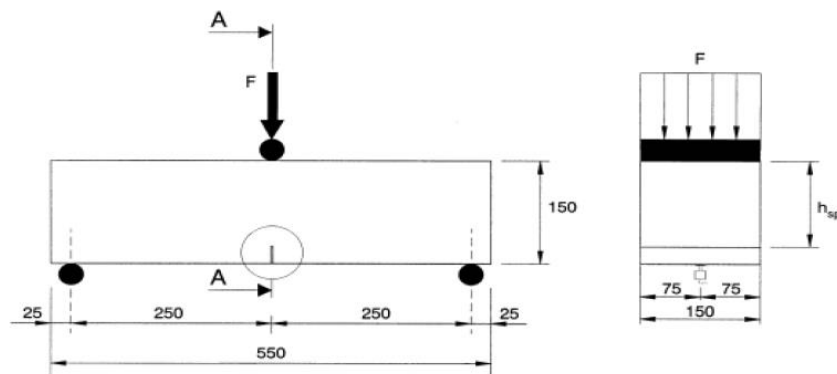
Dimensiones de la probeta de hormigón a ensayar. Fuente: UNE EN-14651
